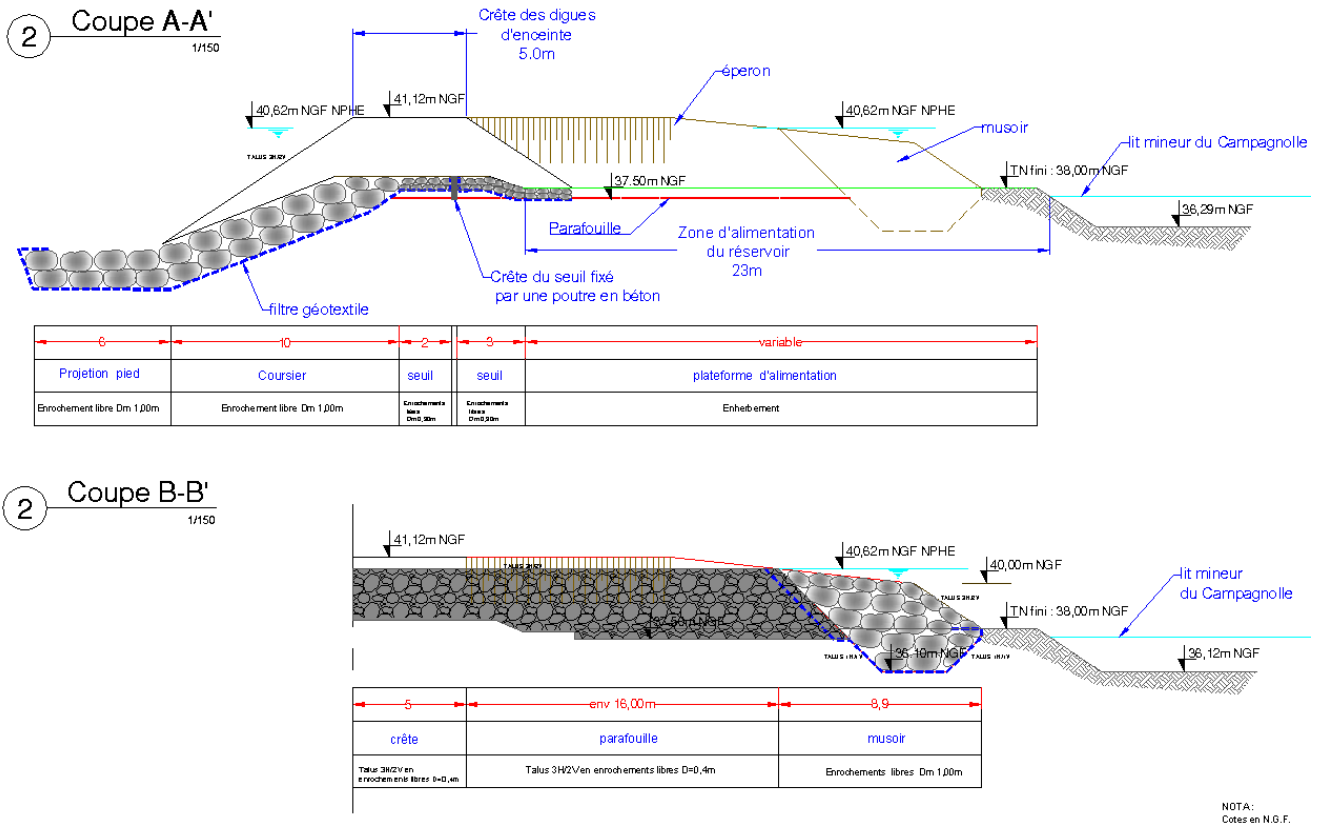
Plan de masse et coupe du déversoir d'alimentation
